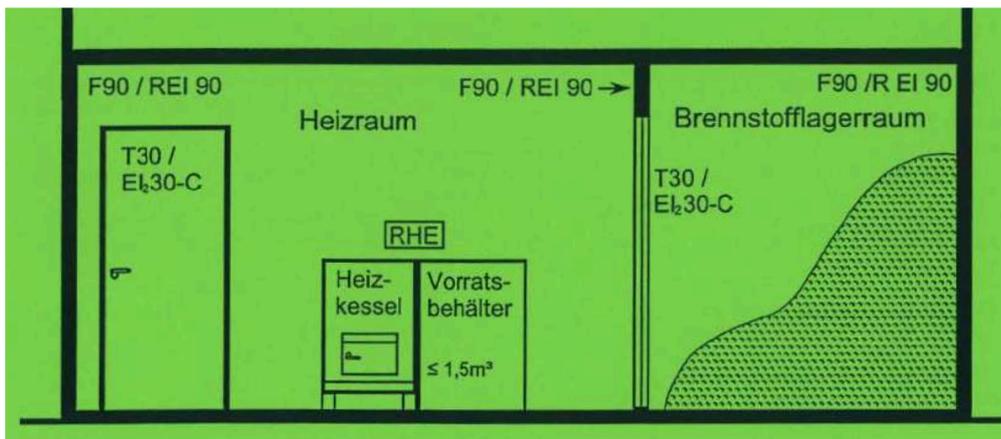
Kompaktanlage im Heizraum (5.1.3) mit anschließendem Brennstofflager (5.1.3), Heizleistung  $\leq 150\text{ kW}$ , Brennstoff gemäß Punkt 3.1 (Hackgut)
